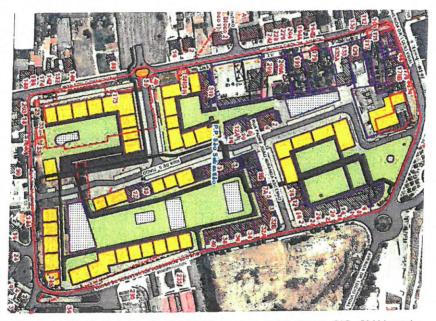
Planta de Implantação PPSS em vigor\_2008 (Fonte: SIG\_CM Vagos)
